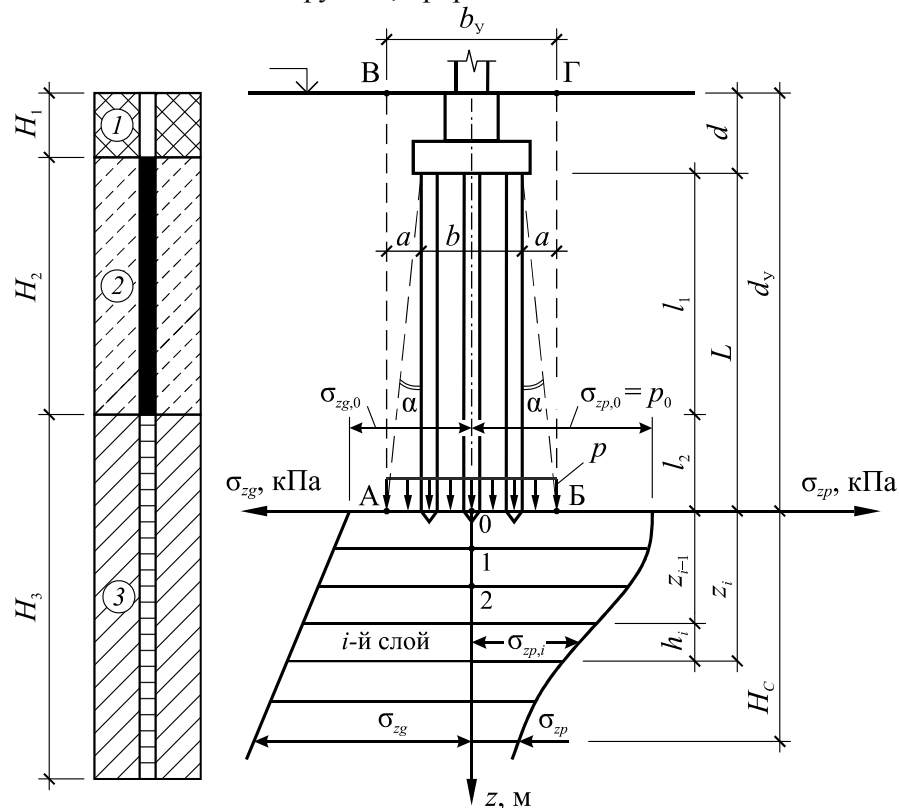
Схема к расчету осадки свайного фундамента как условного фундамента на линейно деформируемом основании (полупространстве) методом послойного суммирования
